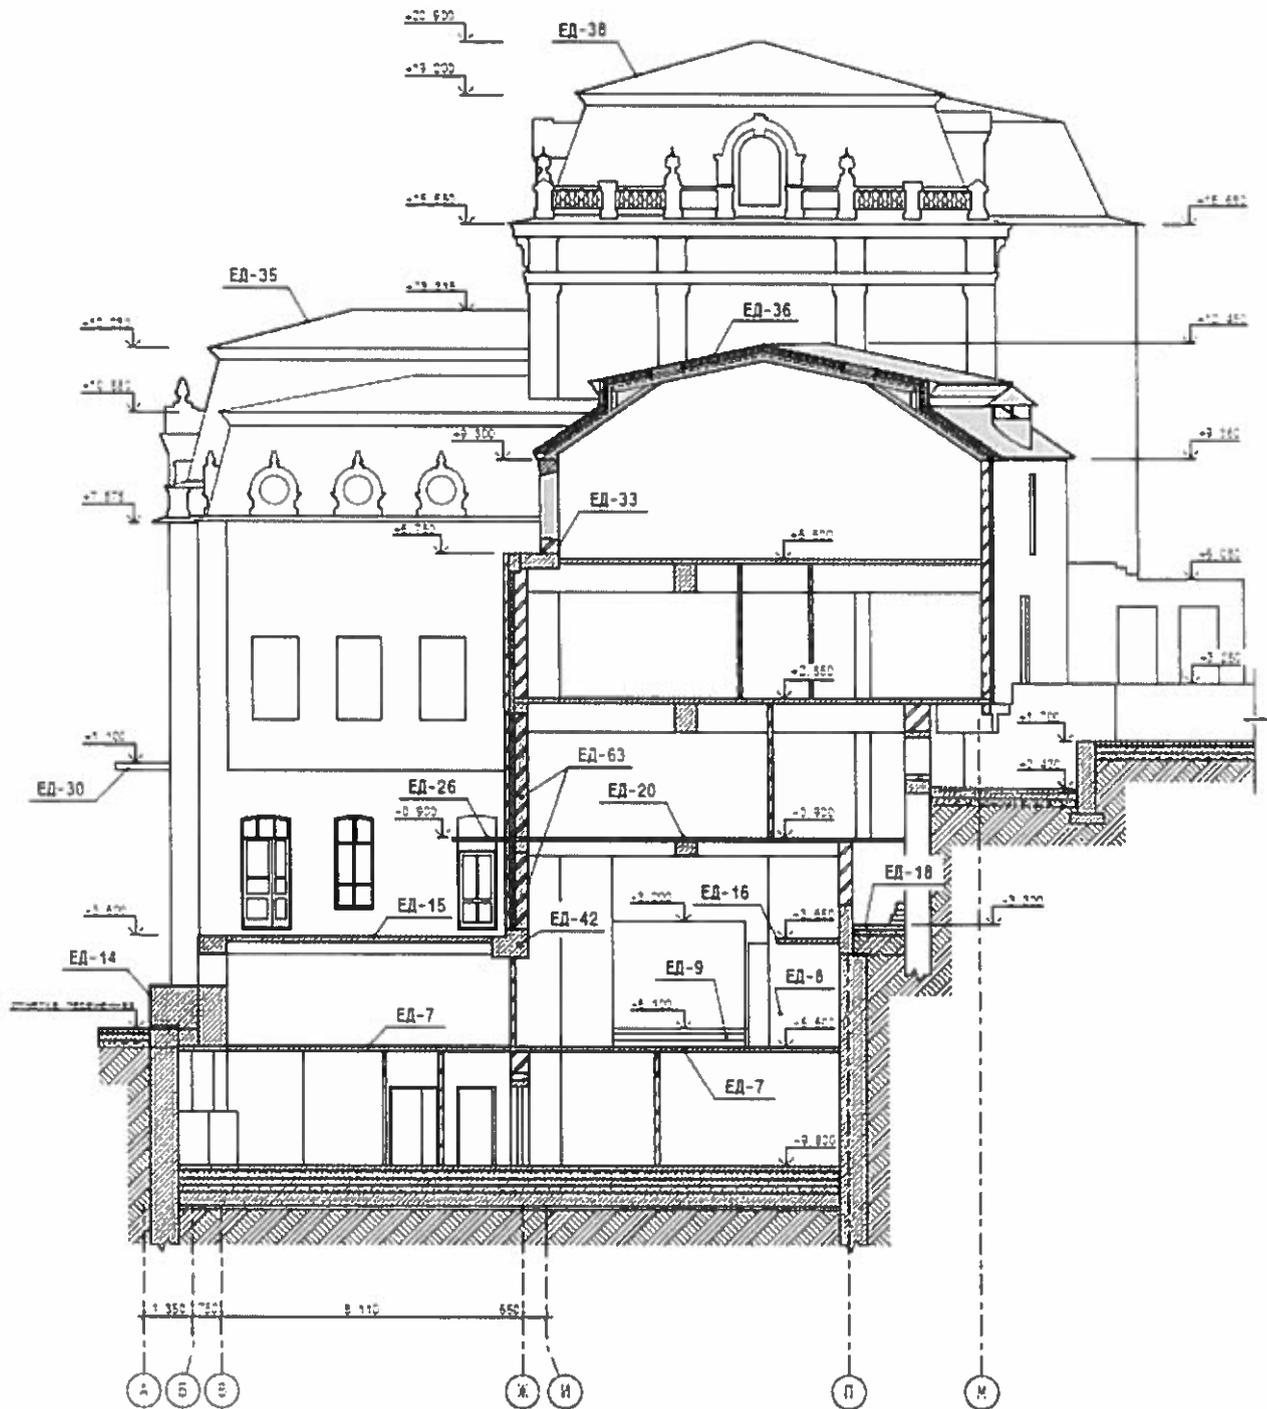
Переріз по будівлі 2-2 [2]
